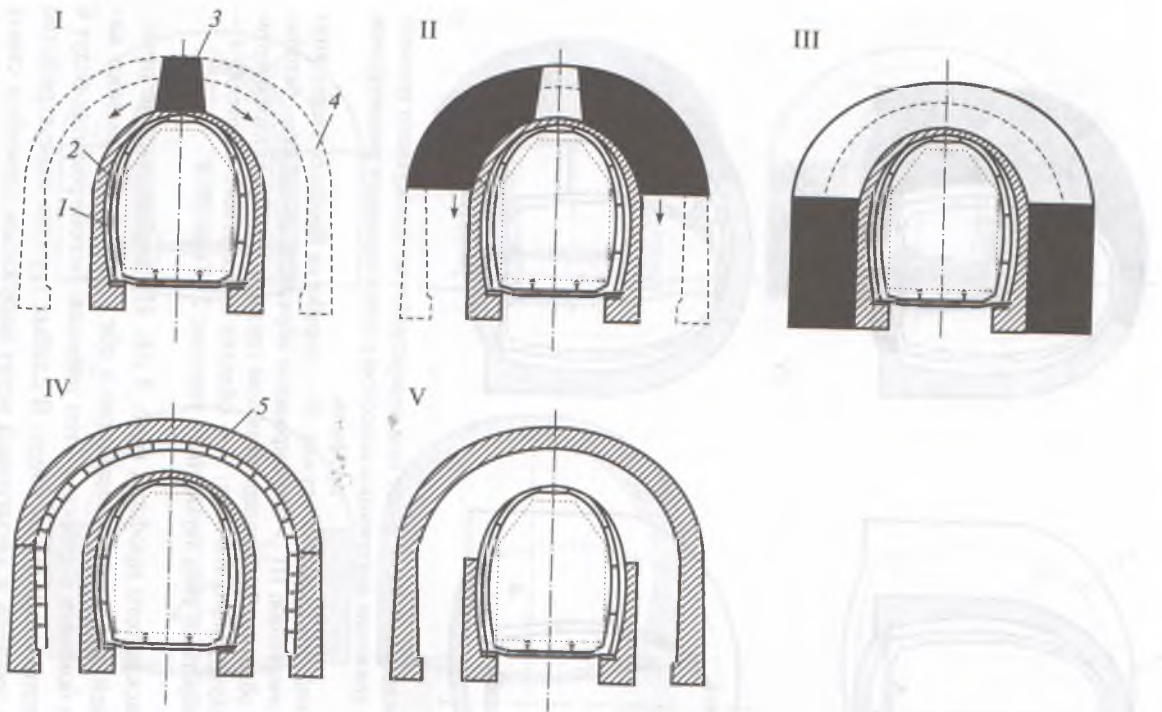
Переустройство однопутного тоннеля под двухпутное движение наружным способом сверху вниз: I — установка поддерживающих кружал и проходка штольни; II — доработка каллотного профиля до проектного очертания обделки двухпутного тоннеля; III — разработка штросса; IV — бетонирование обделки двухпутного тоннеля снизу вверх; V — разборка обделки однопутного тоннеля сверху вниз; 3 — верхняя штольня; 4 — проектное очертание обделки двухпутного тоннеля; 5 — обделка двухпутного тоннеля
